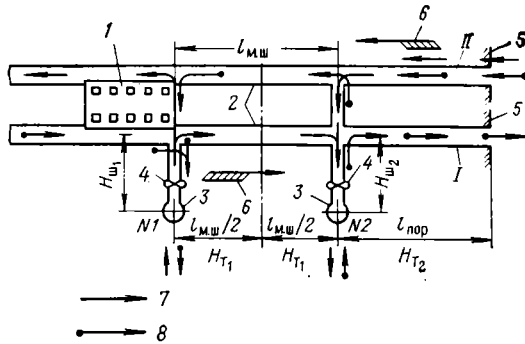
VII. Схема системы вентиляции тоннелей и станций у порталов: 1 — станция метрополитена; 2 — перегонные тоннели; 3 — вентиляционные шахты; 4 — вентиляционные установки; 5 — порталы; 6 — направление движения поездов; 7, 8 — направление движения воздуха соответственно в теплый и холодный периоды года
